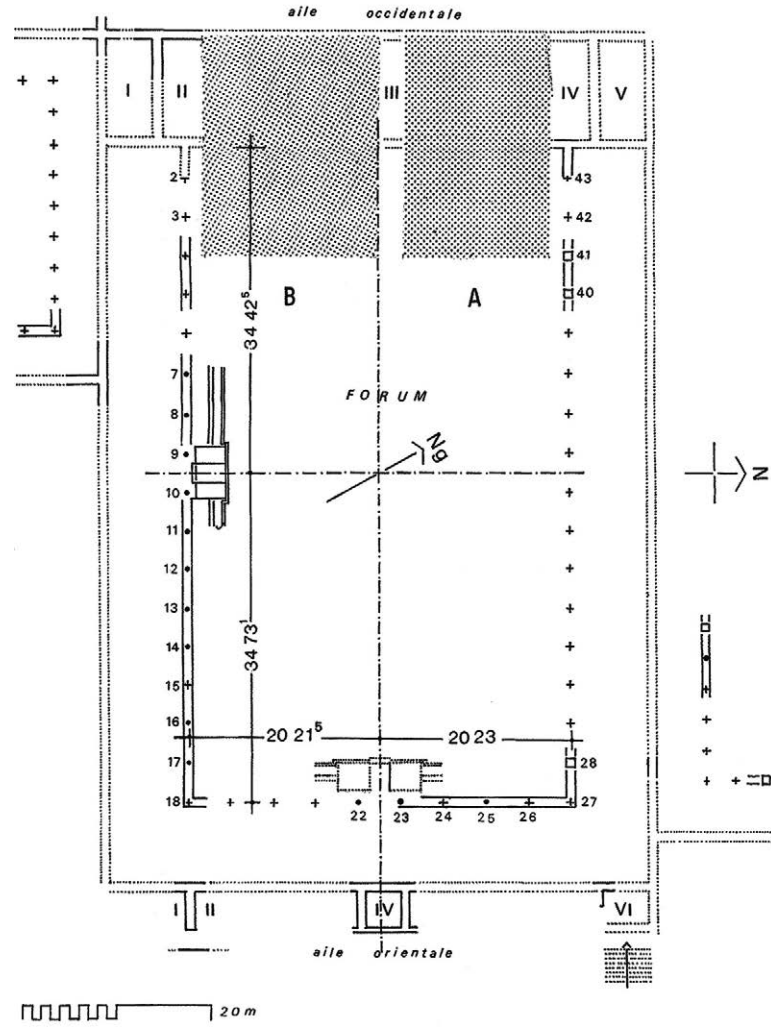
Plan du forum et cotes d'entraxes des portiques (G. Hallier).
